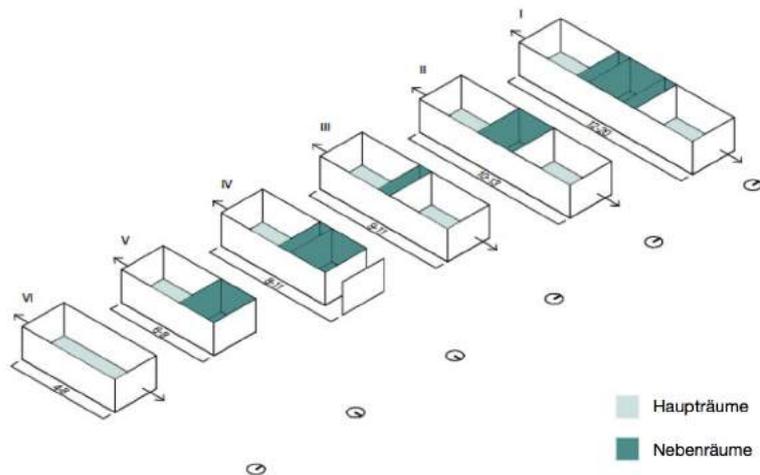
Grundrisstiefen (min. / max.) im Geschosswohnungsbau bei linearer Anordnung; Peter Faller: Der Wohngrundriss, DVA, Stuttgart, 2002
